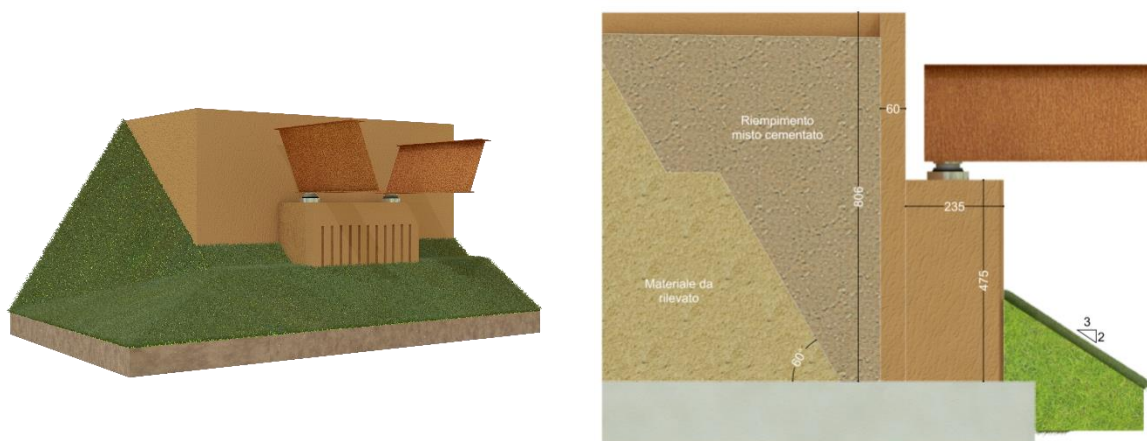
Modello 3d tipologico della spalla e sezione tipologica della spalle
